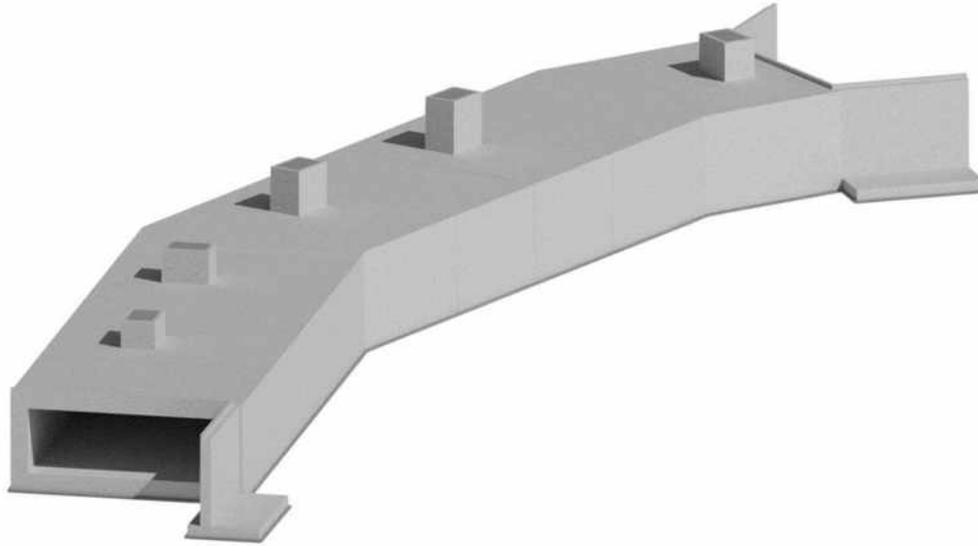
Manufatto scatolare idraulico torrente Faidana. Vista 3D
